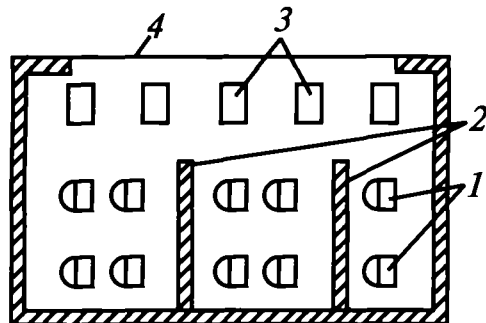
Пример размещения разнотипных рабочих мест и использования перегородок в помещениях большого размера: 1 — рабочие места с дисплеями; 2 — перегородки; 3 — рабочие места без дисплеев; 4 — светопроем
